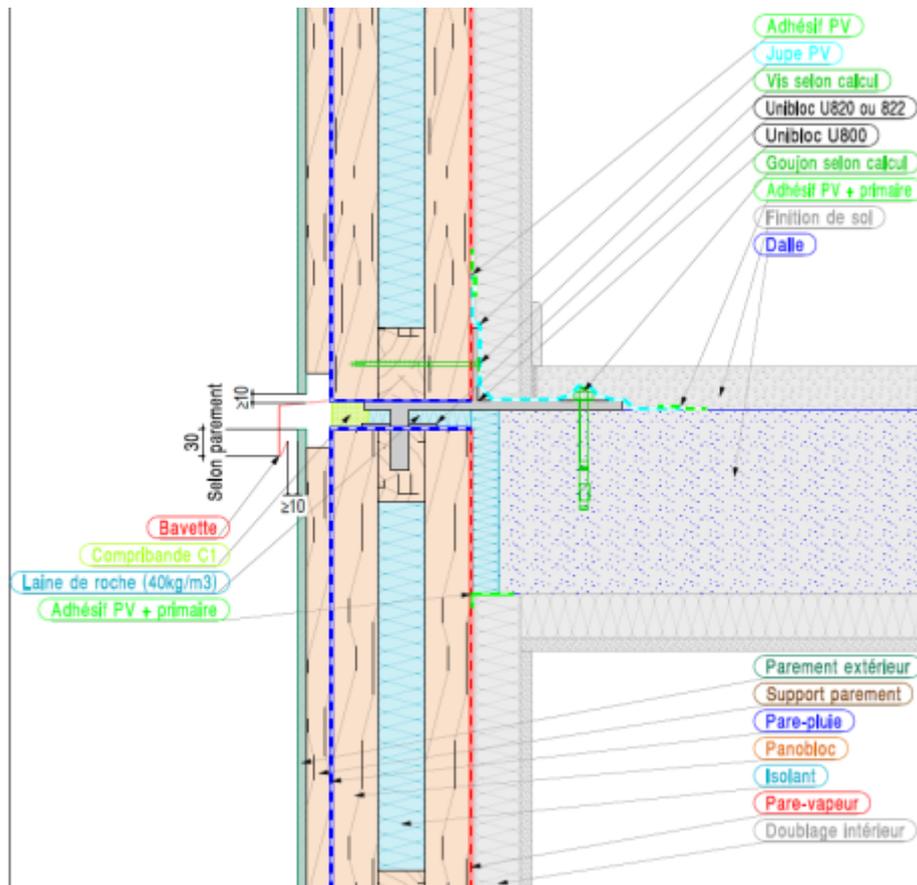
Raccord de panneaux sur dalle béton, avec parement extérieur ventilé / coupe verticale
